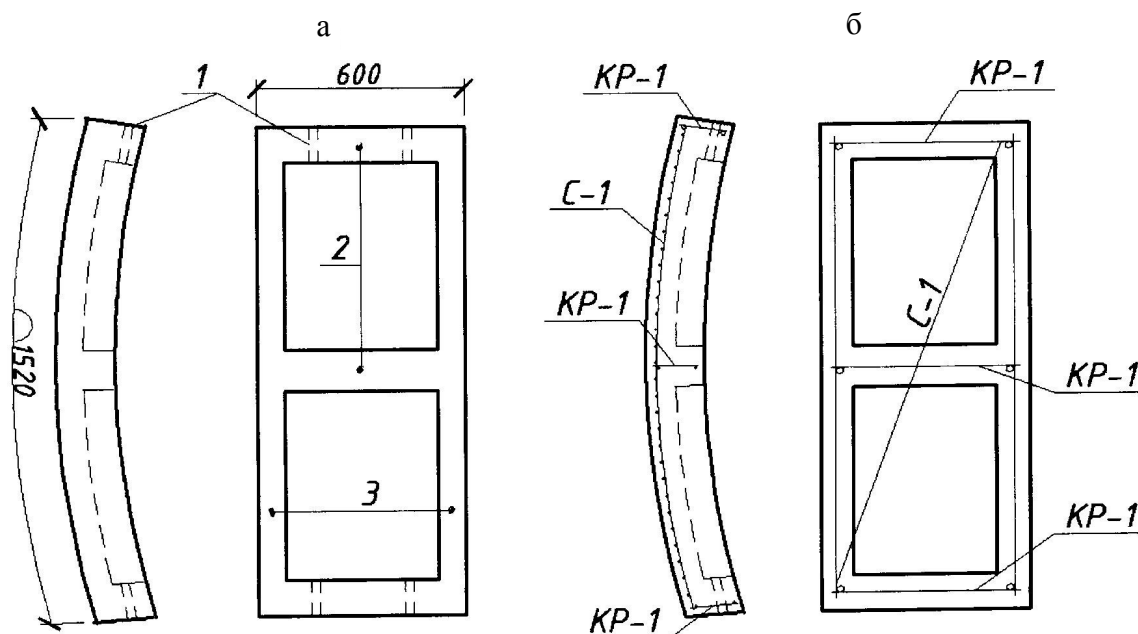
Железобетонный тубинг обделки станционных и перегонных тоннелей: а – основные размеры; б – схема армирования; КР-1 – плоский каркас; С-1 – сварная сетка; 1 – отверстия для скрепления тубингов в кольцо; 2, 3 – поперечные и продольные ребра
